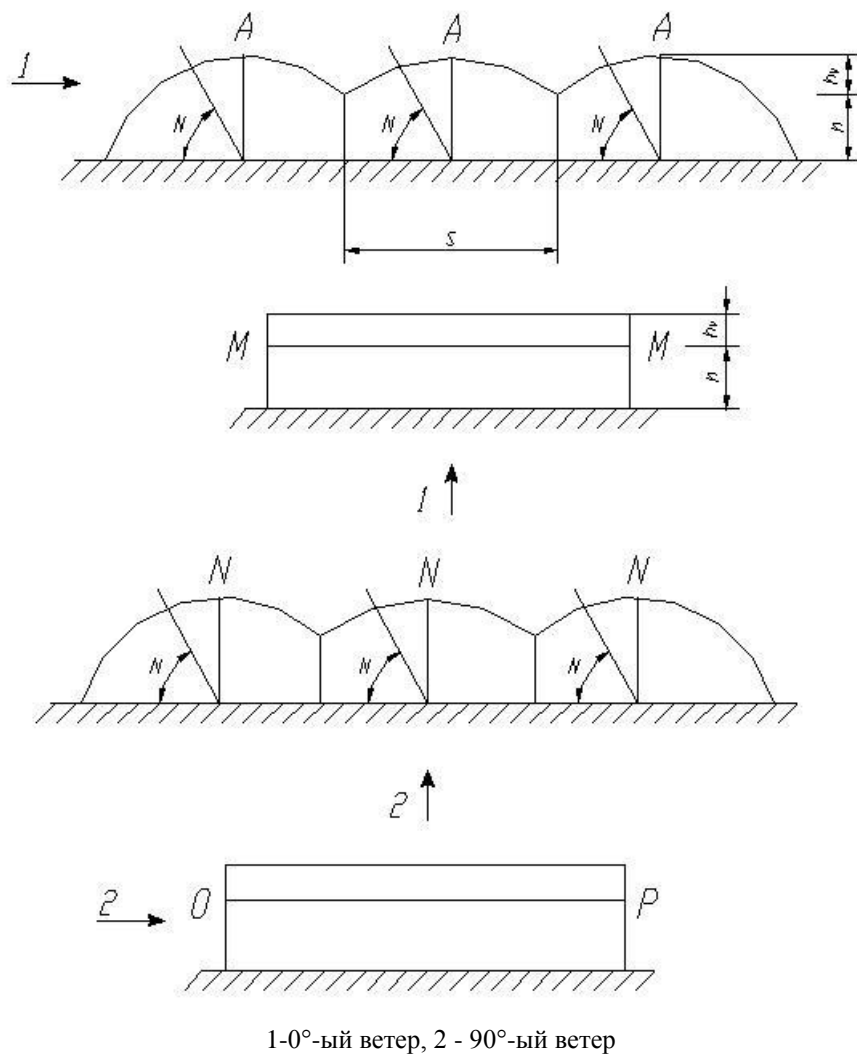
Зоны для сводчатых крыш и стен блочных теплиц без свесов (карнизов) крыши
